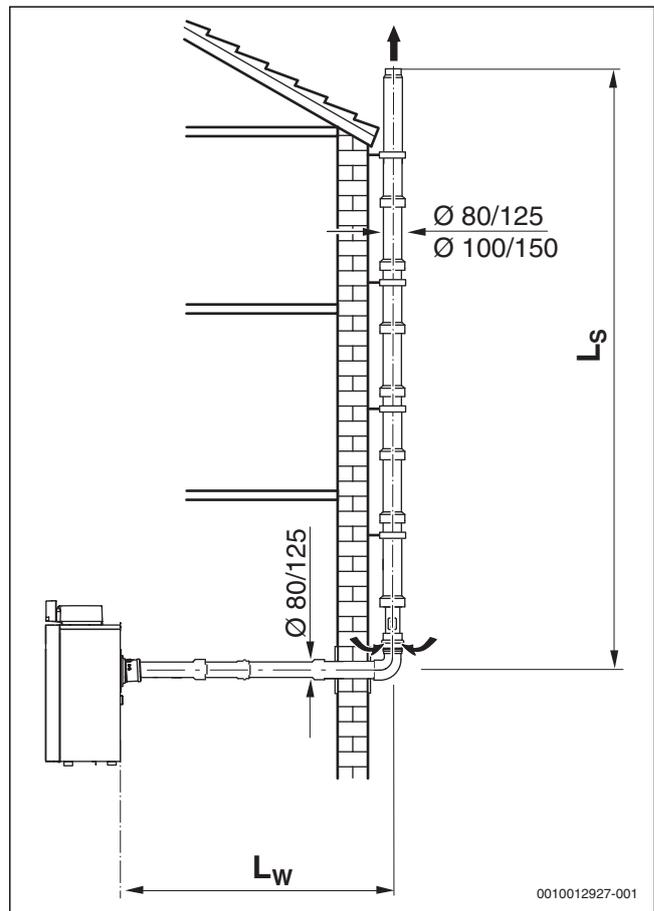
Bitube sur la façade ($C_{53(x)}$)
